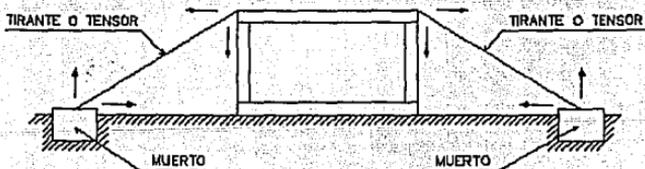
Soporte lateral con tirantes o tensores exteriores.
